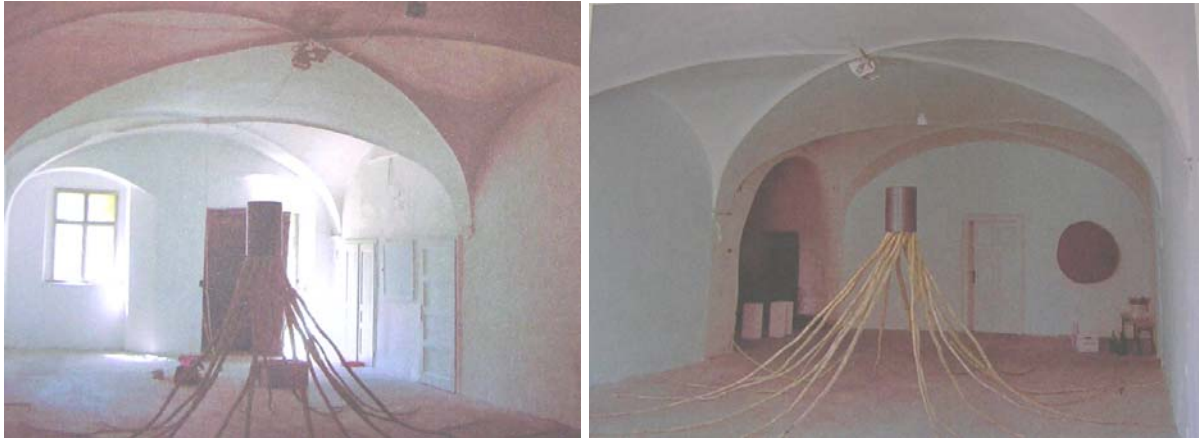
Halle im Erdgeschoss des Schlosses Wolfpassing mit den Gewölbeformen.
